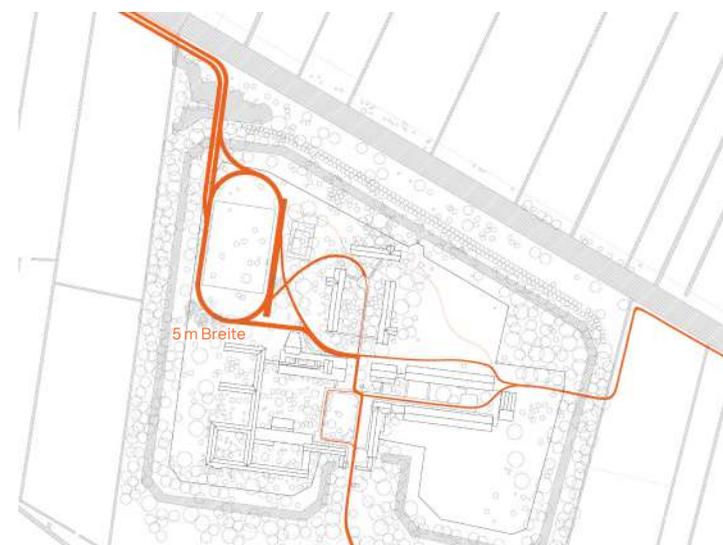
Ausgebauter Radweg und Zufahrtsstraße als Rettungsweg
